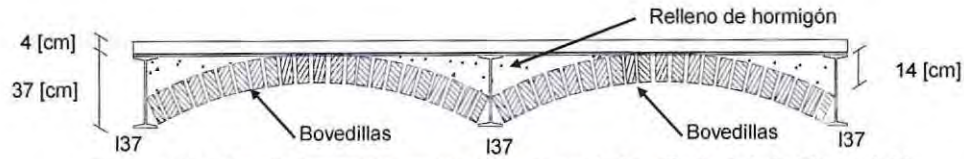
Detalle bovedillas entre vigas secundarias. Corte 1-1 de Figura 1.11.
